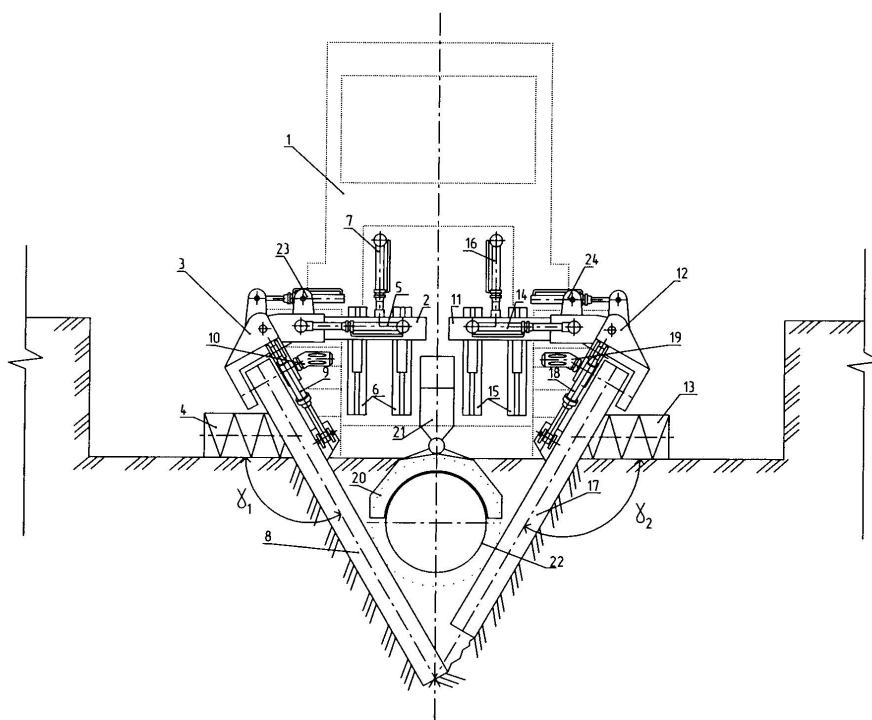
Конструктивная схема цепного экскаватора для подкопа трубопровода, где: 1- базовое шасси; 2, 11 - рама; 3, 12 – рабочий орган; 4, 13 – эвакуатор грунта; 5, 14 – гидроцилиндр; 6, 15 – направляющие; 7, 16, 18 – гидроцилиндр; 8, 17 – цепная секция; 10, 19 – гидродвигатель; 20 – копирное устройство; 21 – гидроцилиндр; 22 – опора на трубопровод; 23, 24 – поворотные механизмы
